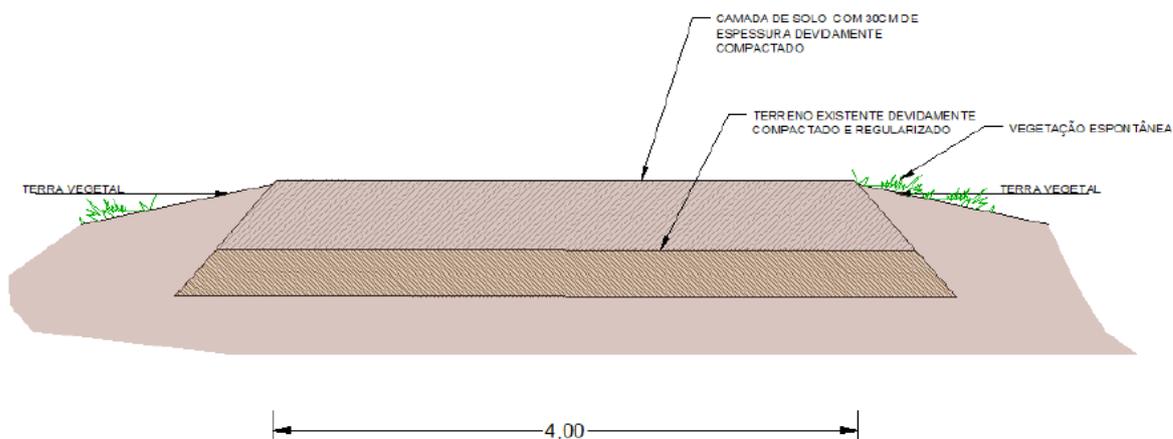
Perfil Transversal tipo do caminho interno (sem valeta, a construir).
